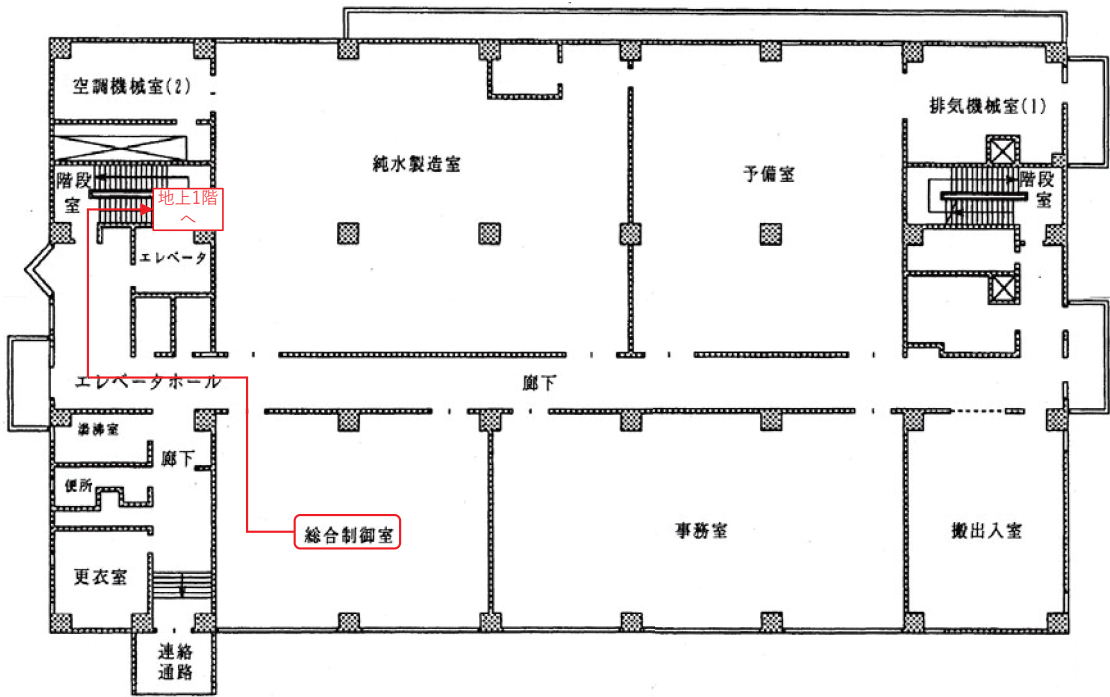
(1) 移動経路 (ユーティリティ施設 3F 平面図)
